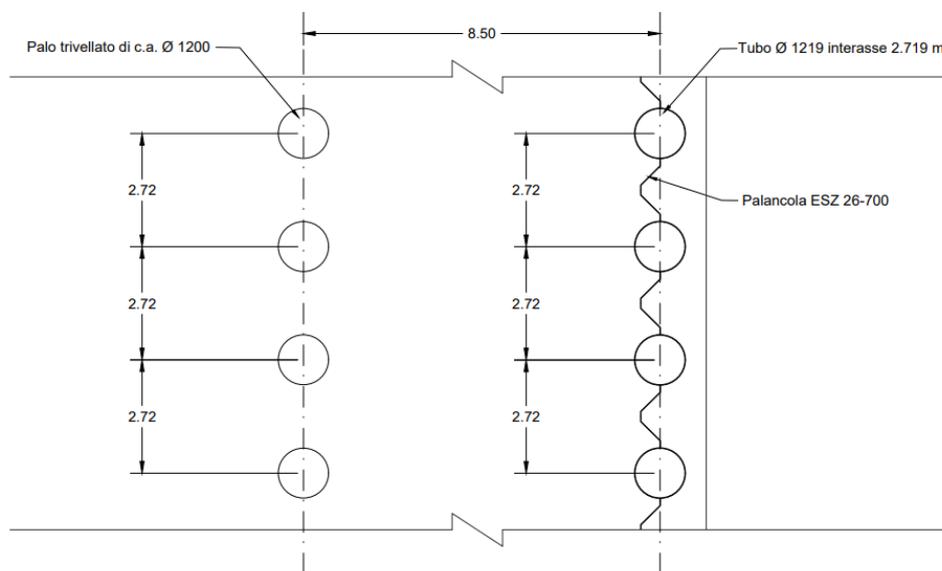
Stralcio planimetrico delle fondazioni profonde di progetto
